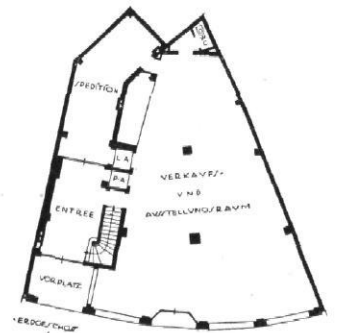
und 15 | Geschäftshaus in Köln | Architekt: Paul Pott, Köln | Grundriß Maßstab 1:500
